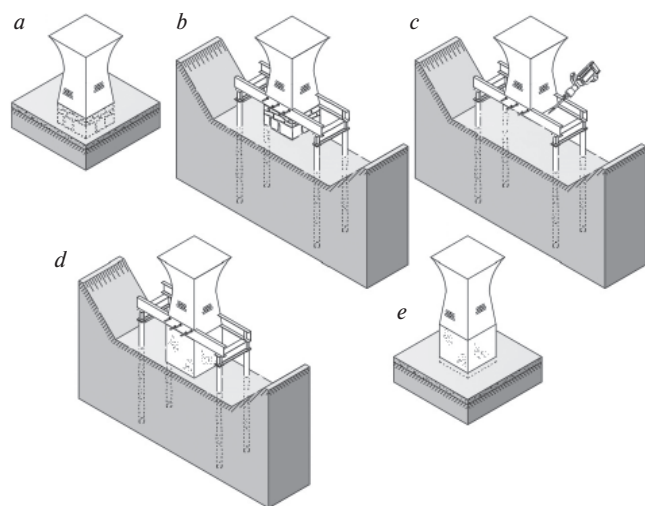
Процесс заглубления подвала: а – исходный вид кирпичного столба в подвале; б – вывешивание столба на буроинъекционных сваях; с – разборка старого бутового фундамента; д – устройство нового ж/б фундамента под столб; е – демонтаж временных конструкций
